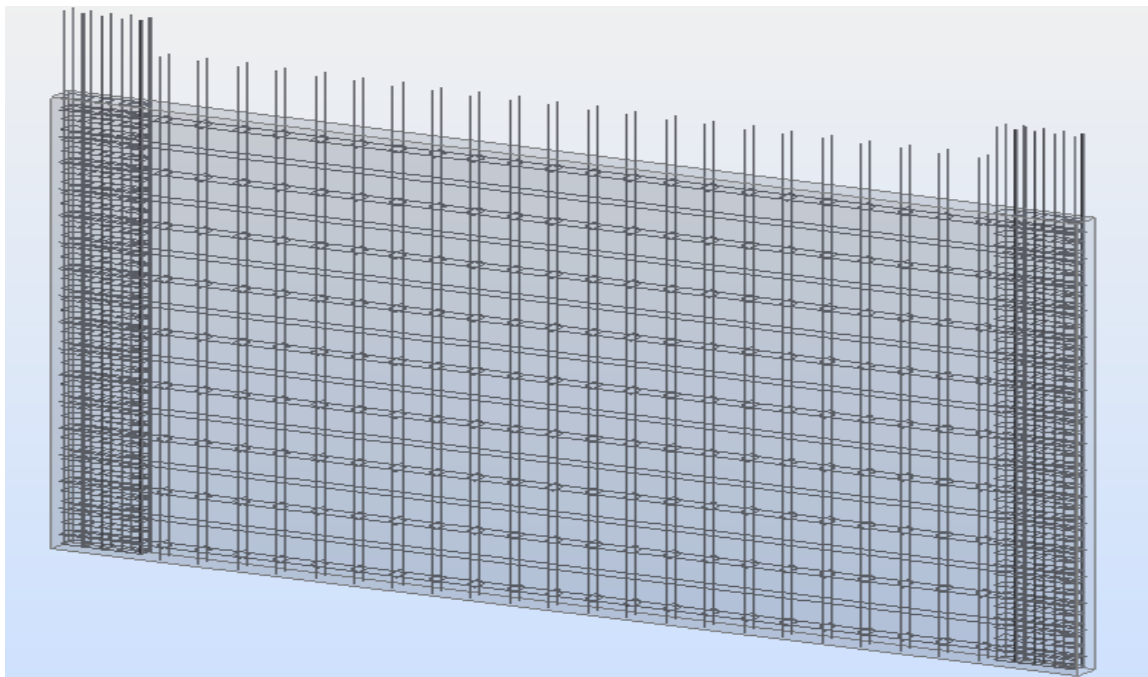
Schéma de ferrailage des murs voiles en 3D
